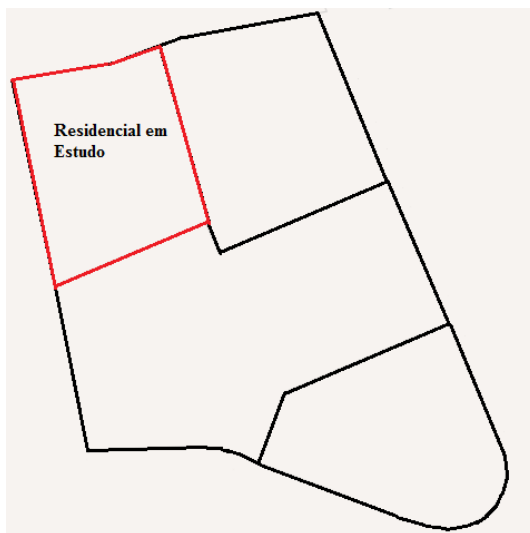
Croqui do canteiro de obras – Em destaque a torre em estudo
